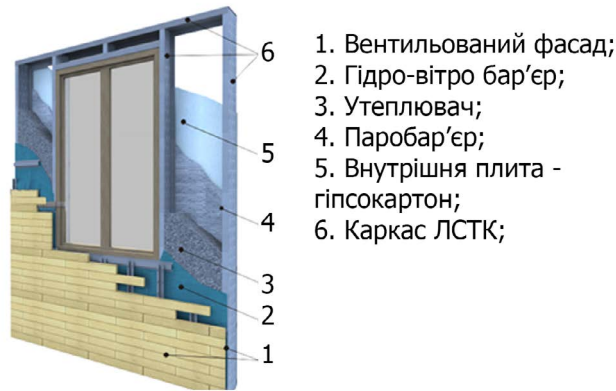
Схема каркасу ЛСТК з вентиляваним фасадом
